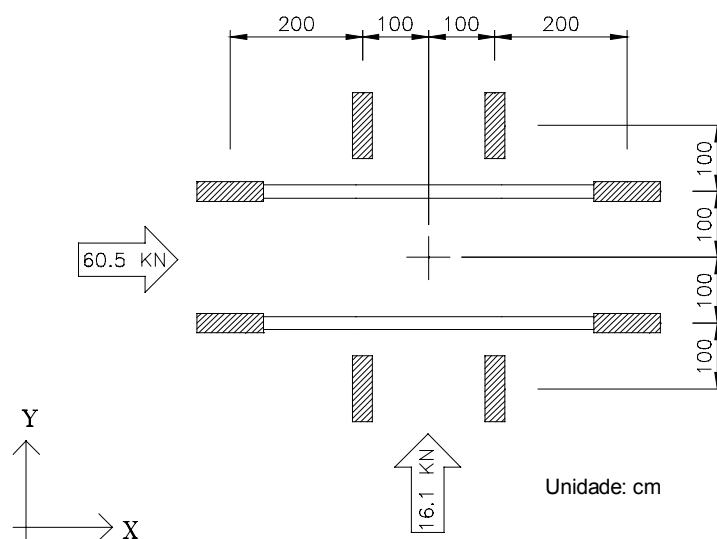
Estrutura sem consideração das vigas secundárias - caso 04
